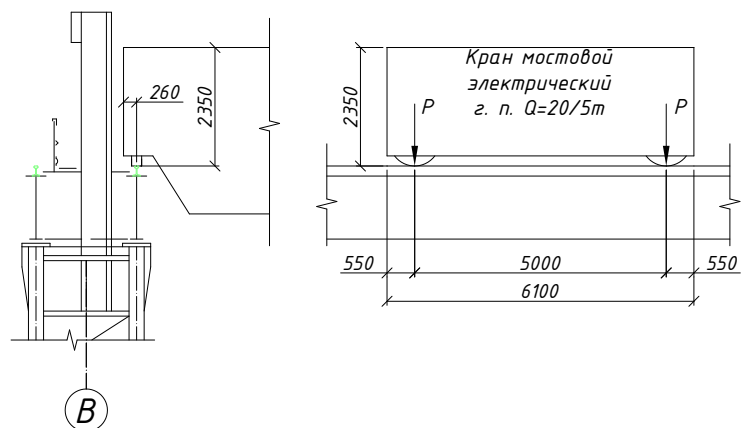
Схема опирания крана пролёта отделки на рельсовый путь
